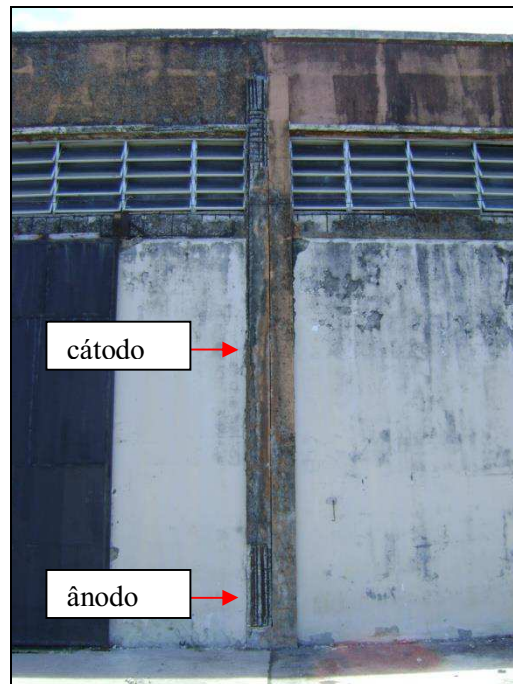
Delimitação das zonas anódicas e catódicas no pilar do Armazém 6.
